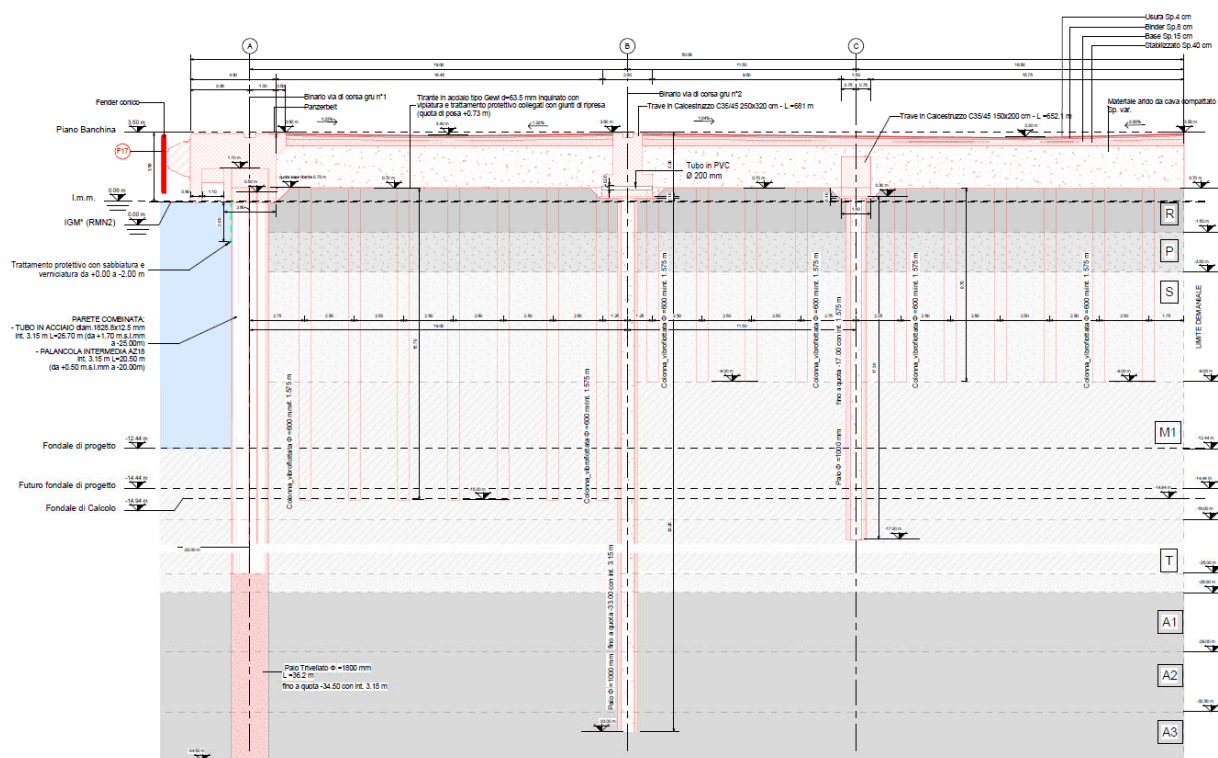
Sezione adeguata della banchina FUTURO CTS – tratto privo di banchina
